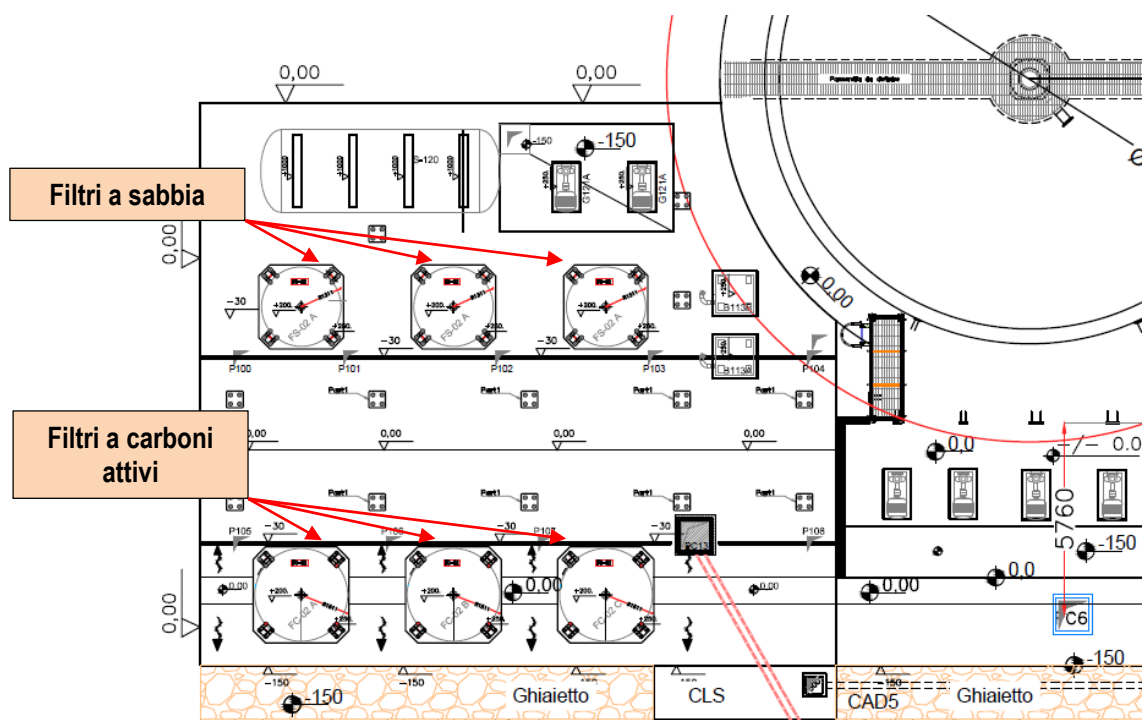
Stralcio planimetrico per l'individuazione degli elementi delle unità filtranti a servizio della linea TAS
